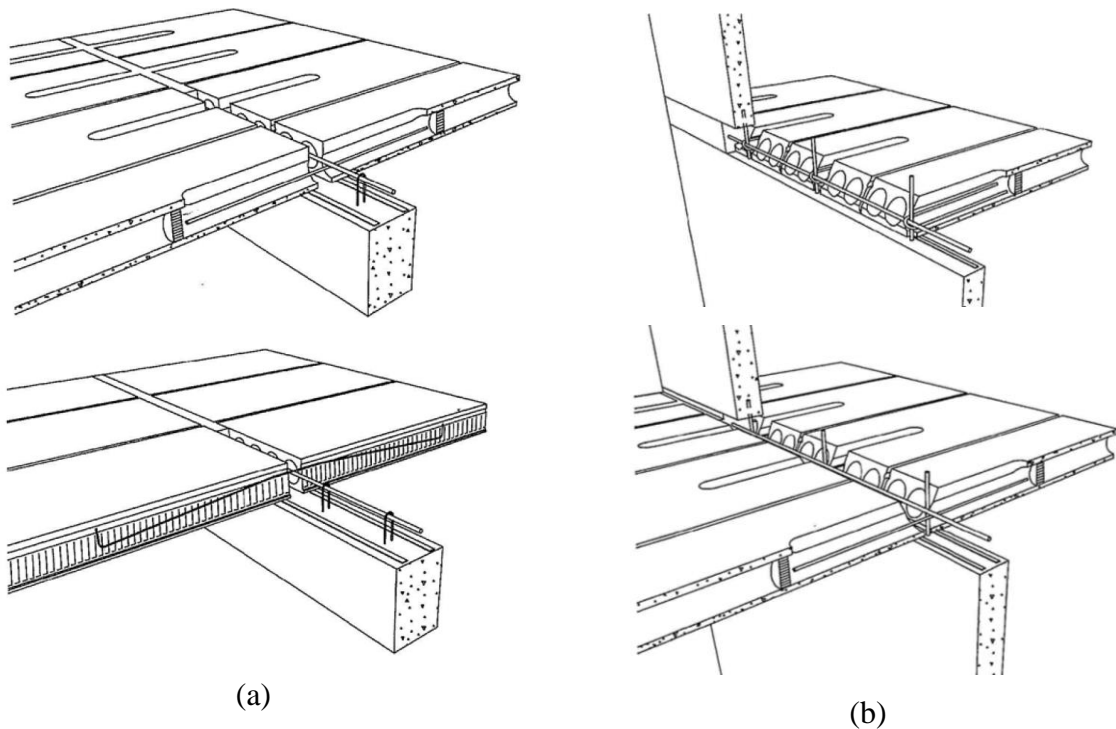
Tipos comuns de ligações (a) laje-laje, (b) parede-laje (fonte: FIB, 2011)
